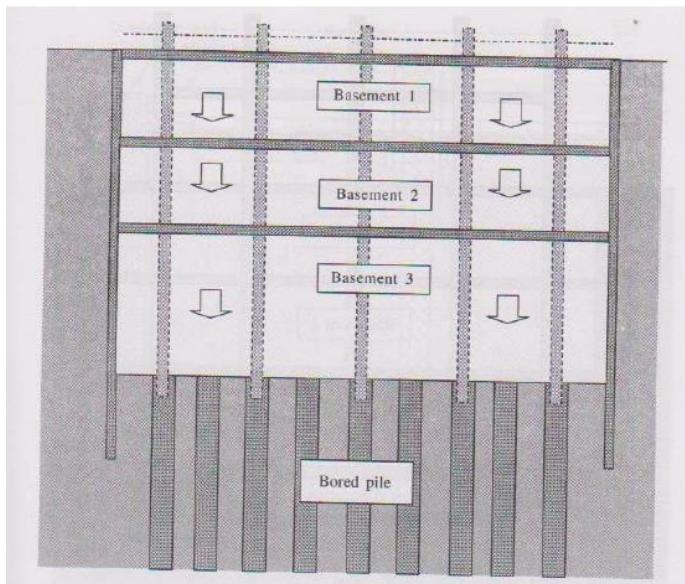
Pengecoran lantai basemen 1 dan 2
